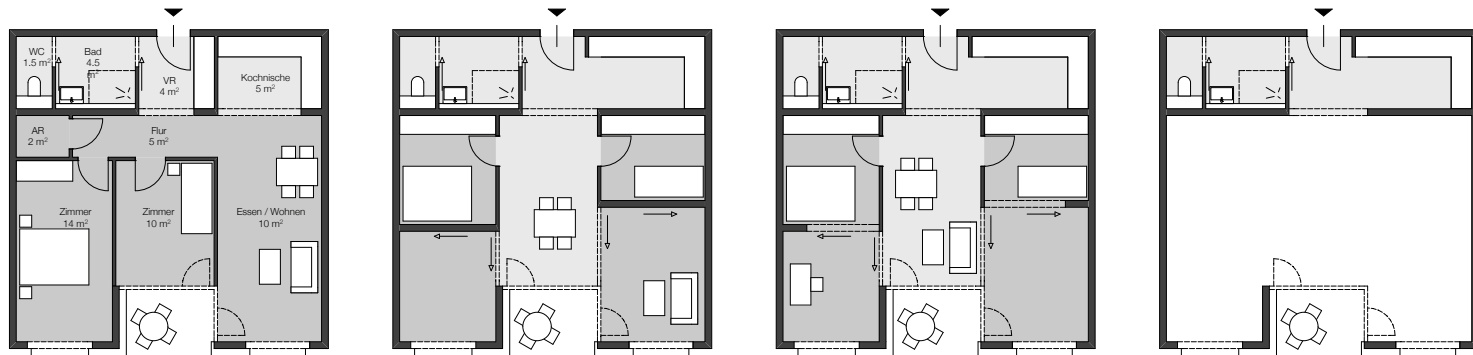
Varianten der Grundrisse für eine SMART-Wohnung, eine halböffentliche Nutzung wäre ebenfalls möglich, wie im Grundriss ganz rechts ersichtlich (eigene Darstellung nach wohnfonds\_wien, 2013, S. 8)
